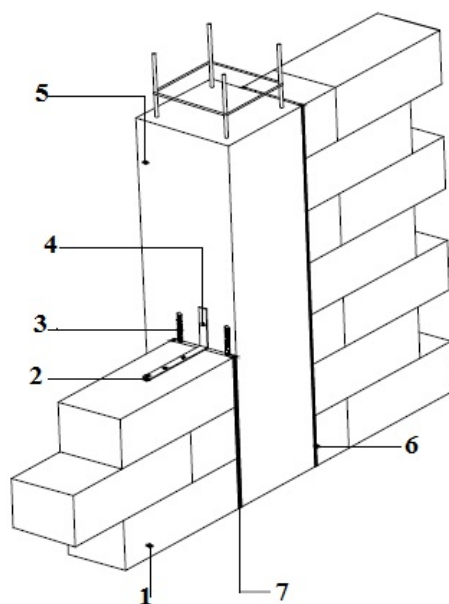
Соединение стены, заполняющей каркас, с железобетонной колонной (каркасно-монолитное строительство): 1 — стена из блоков YTONG; 2 — металлический соединитель; 3 — пароизол; 4 — анкер; 5 — железобетонная колонна; 6 — герметизирующая нетвердеющая мастика; 7 — пенополистирол, 10 мм
